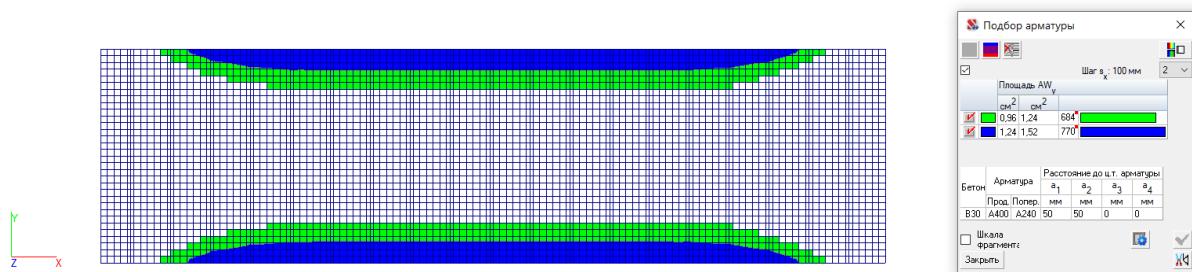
Армирование монолитной плиты - поперечная по У
